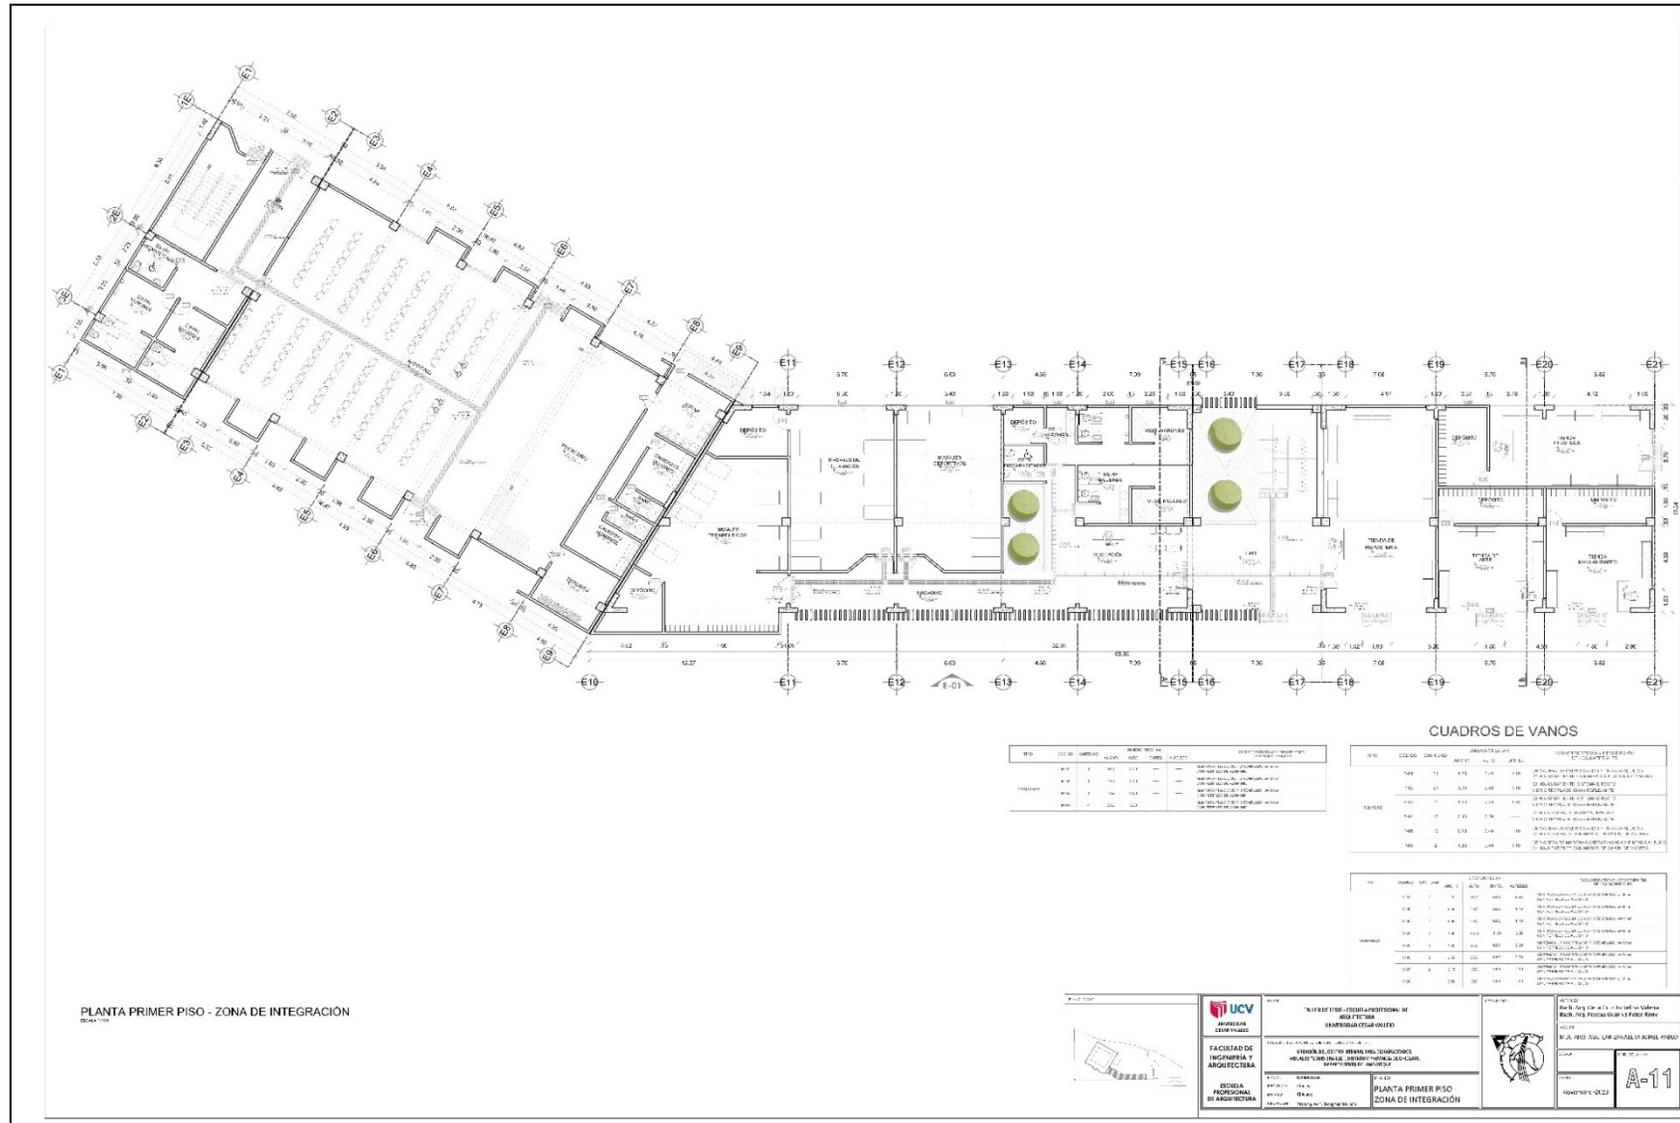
Planta primer nivel-zona de integración. Fuente: Elaboración propia.
